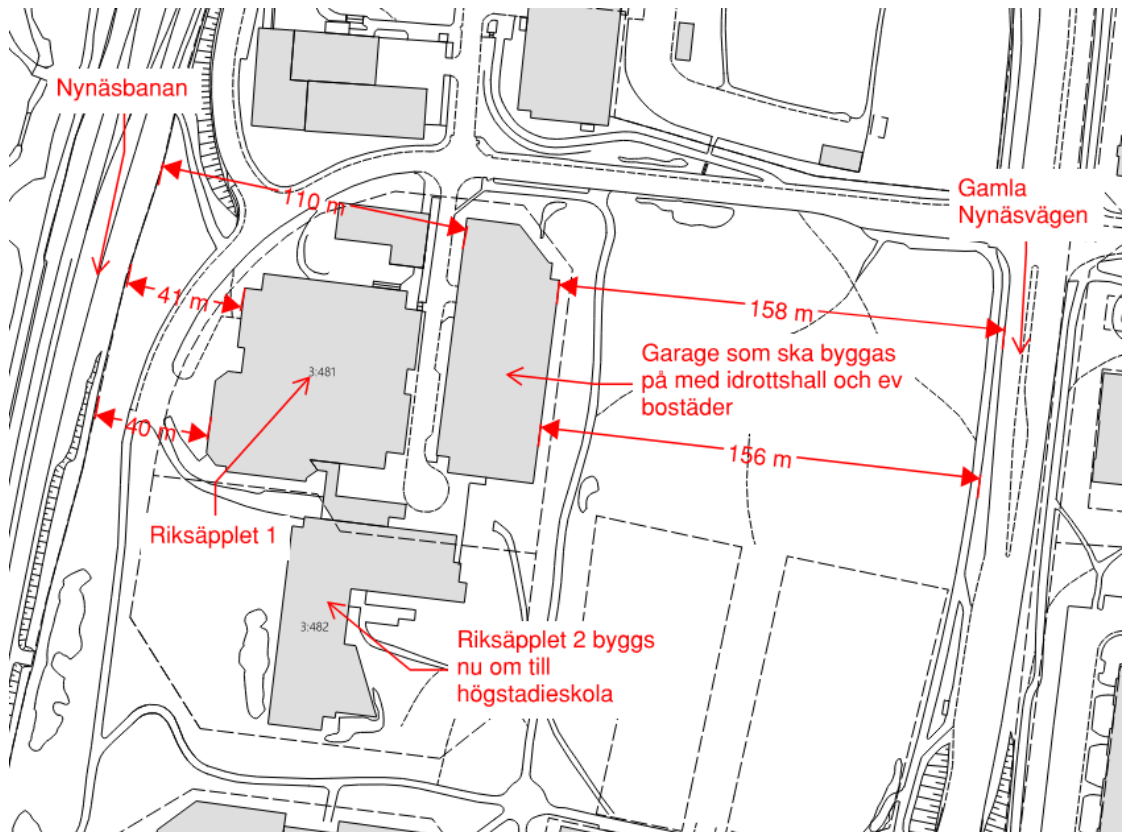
bild på planområdet, från planuppdrag Dnr: PLAN.2018.32 (Haninge kommun, 2019).
